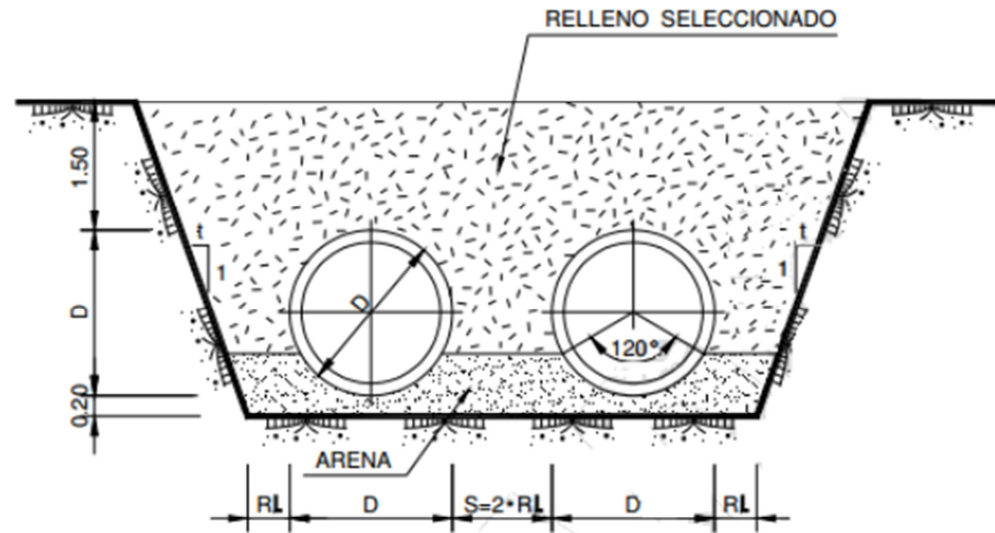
Sección Tipo Perfil Transversal Zanja y Tubería
